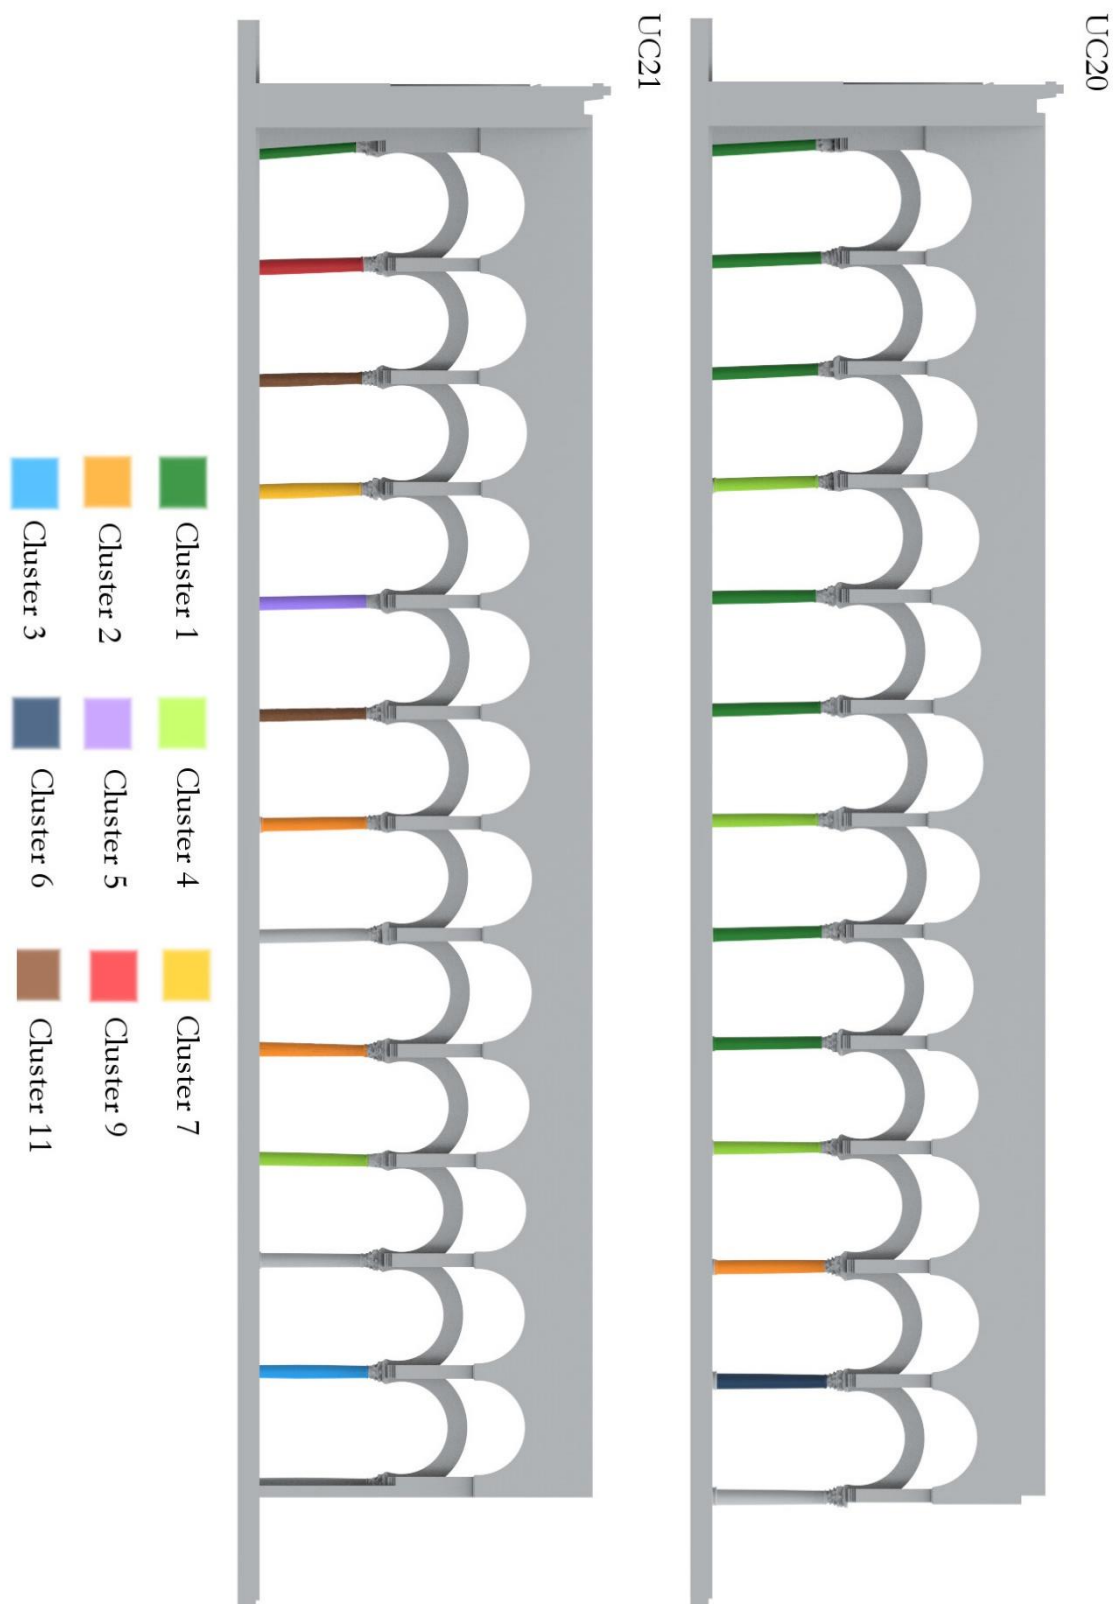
Alzado de las Unidades Constructivas (UC20-UC21) con los Clúster de los Fustes.
